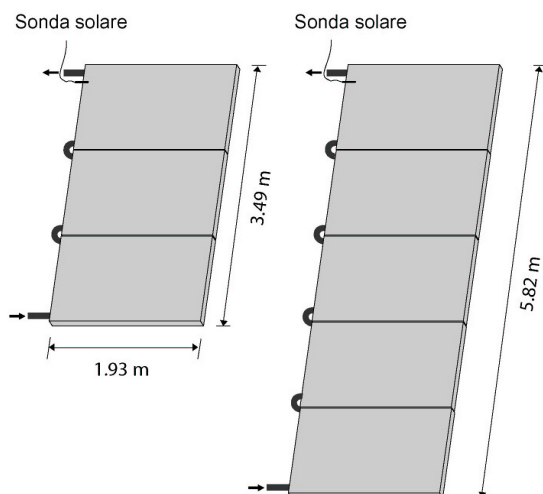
Collegamento in serie di collettori orientati orizzontalmente (max. 5 Helio Plan 2.2 in serie)
